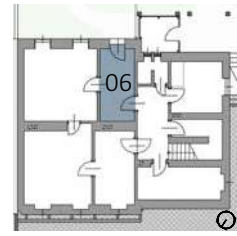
Grundriss UG 06 Sommerküche, M=1:100.
